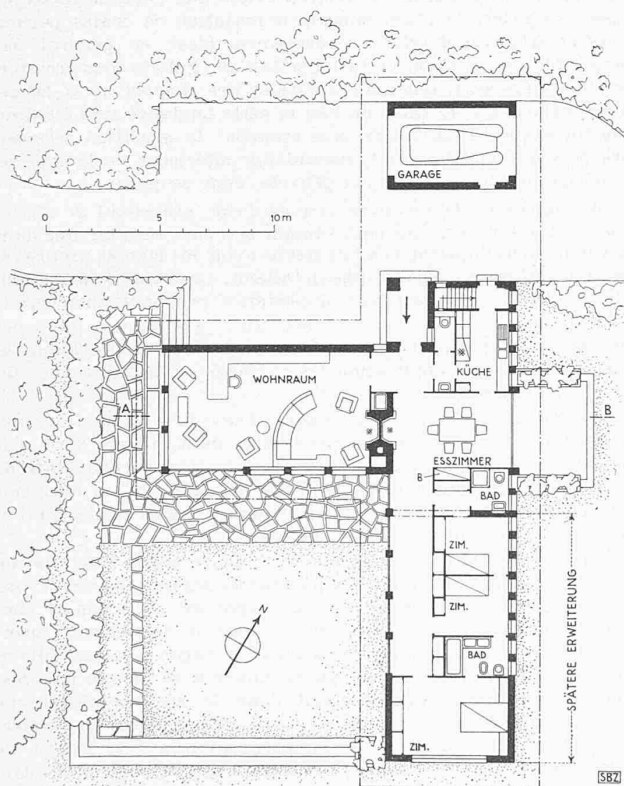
Ferienhaus «Bois Chamblard». — Grundriss u. Schnitt 1:300
